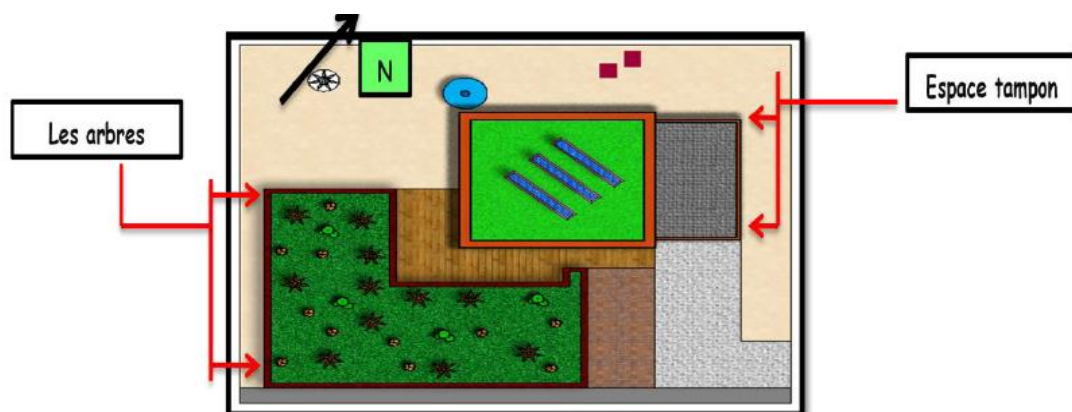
plan de masse représente l'espace tampon et les arbres , Source : auteurs
